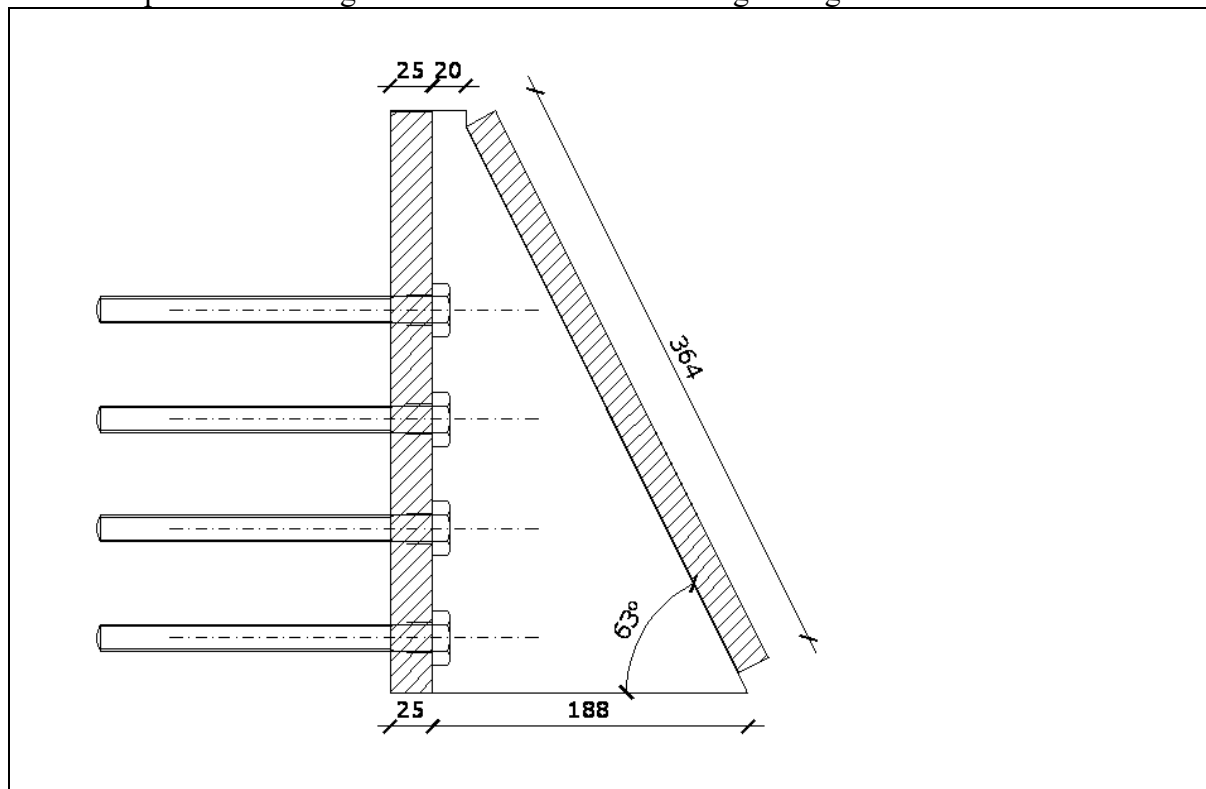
Geometria ritegno longitudinale su spalla – lamiere di appoggio
